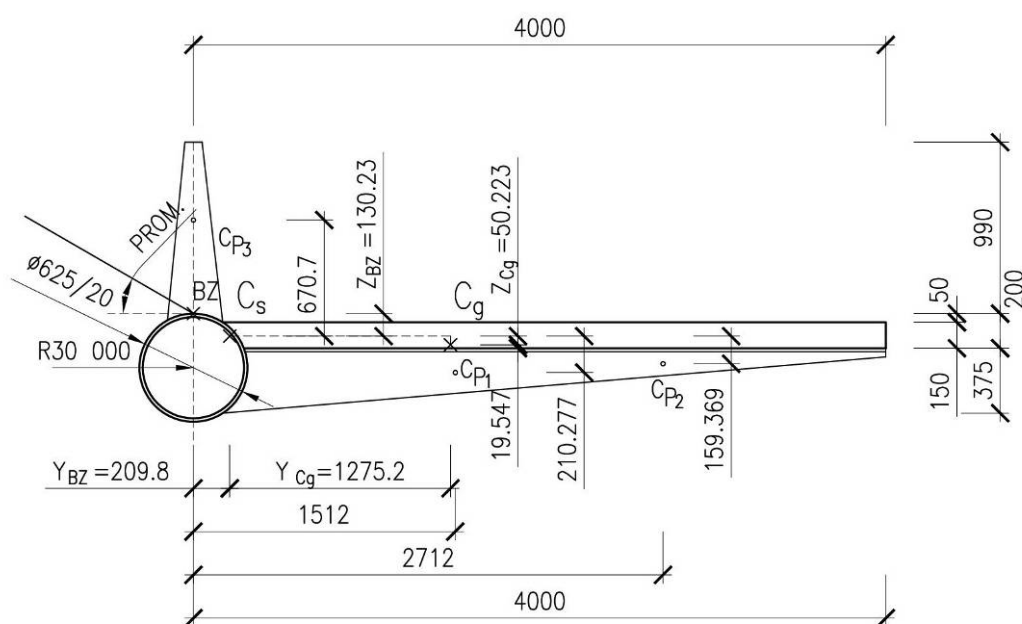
Schematický půdorys a pohled studie visuté konstrukce
